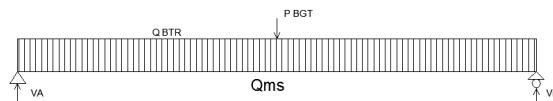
24 Permodelan Beban Mati Girder Tengah Bentang 15,5M
